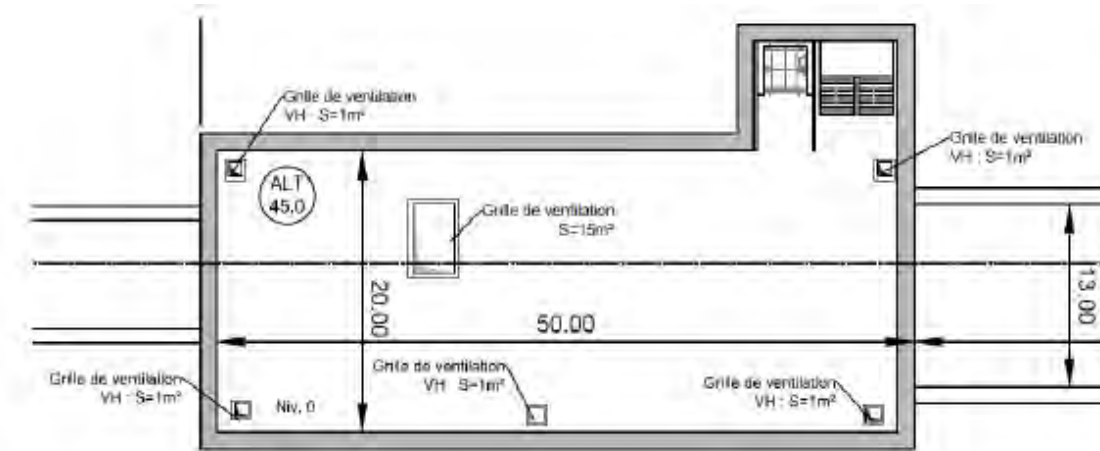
Plan d'installation du CDT au RDC (Source : RATP)
